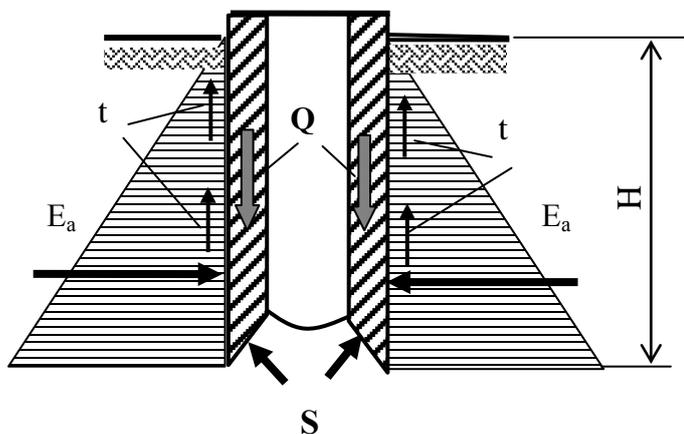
Схема нагрузок, действующих на колодец в последний момент погружения:
